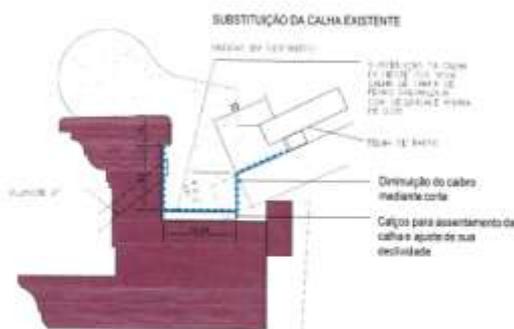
Desenho ilustrativo para implantação de calha metálica.
